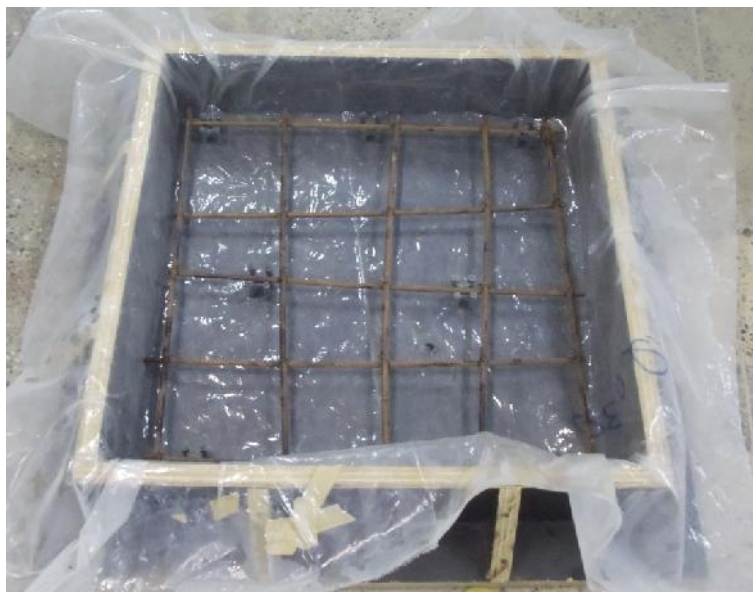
Forma de madeira com armadura de aço, espaçadores e capa plástica
